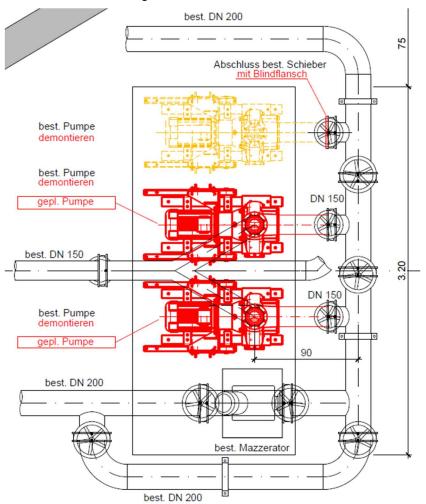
Grundriss Aufstellung Umwälzpumpen Faulung
